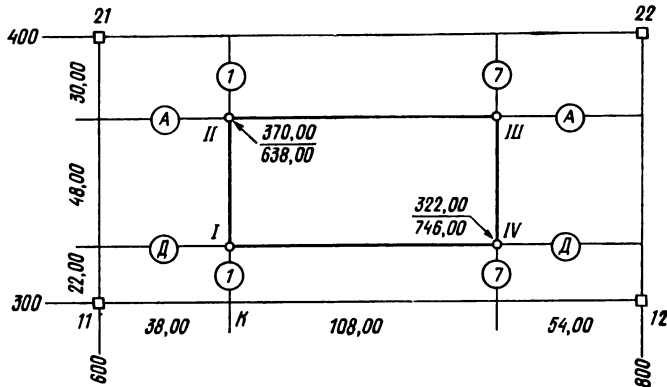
Разбивка сооружения от пунктов строительной сетки
